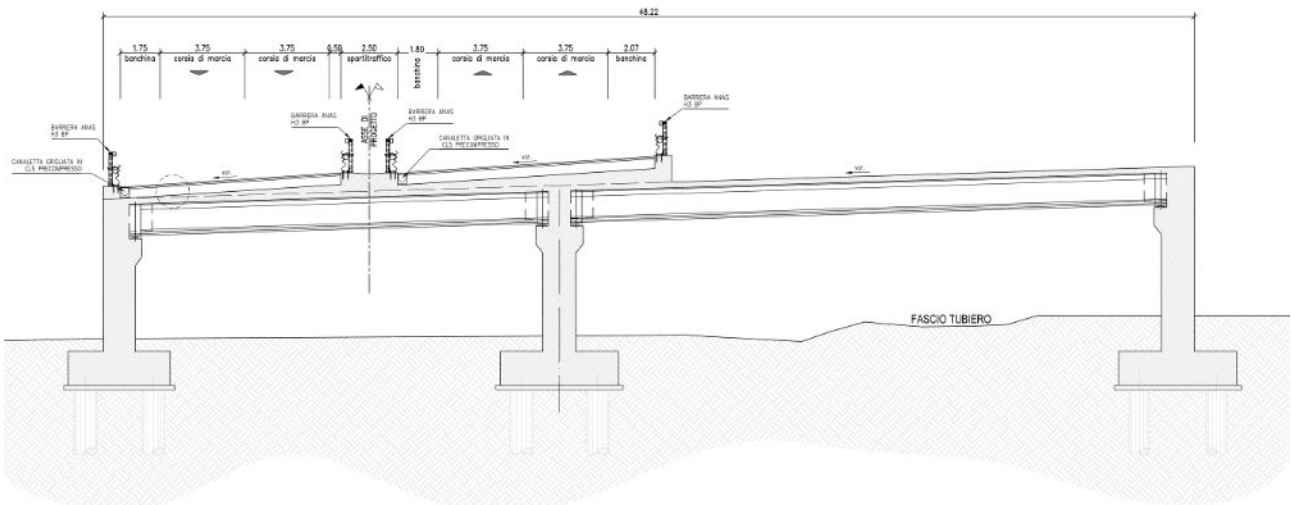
Sezione tipo dell’asse principale su opera di attraversamento
